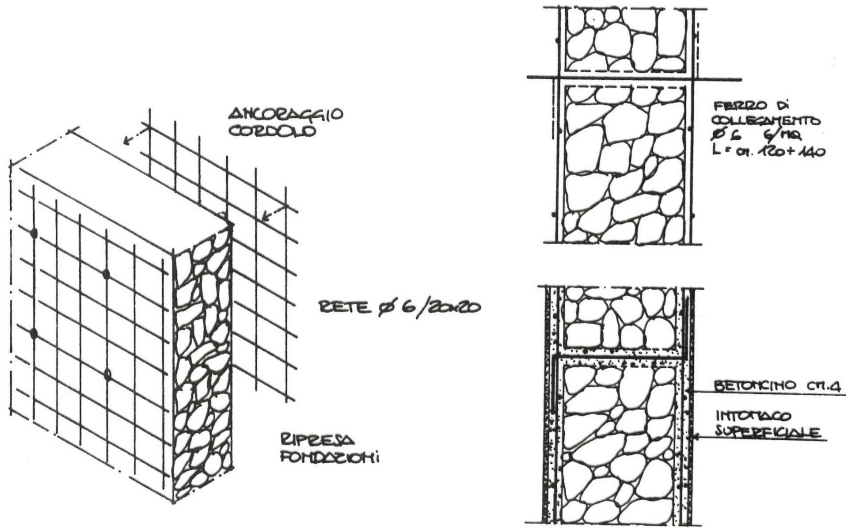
Esempio di intervento di consolidamento con “rete e betoncino” tratto dalla Legge Regionale n° 30 del 1977. Lo scopo di tale lavorazione era quello di consolidare le murature mediante la realizzazione di getti di betoncino armato opportunamente solidarizzato alla muratura.
